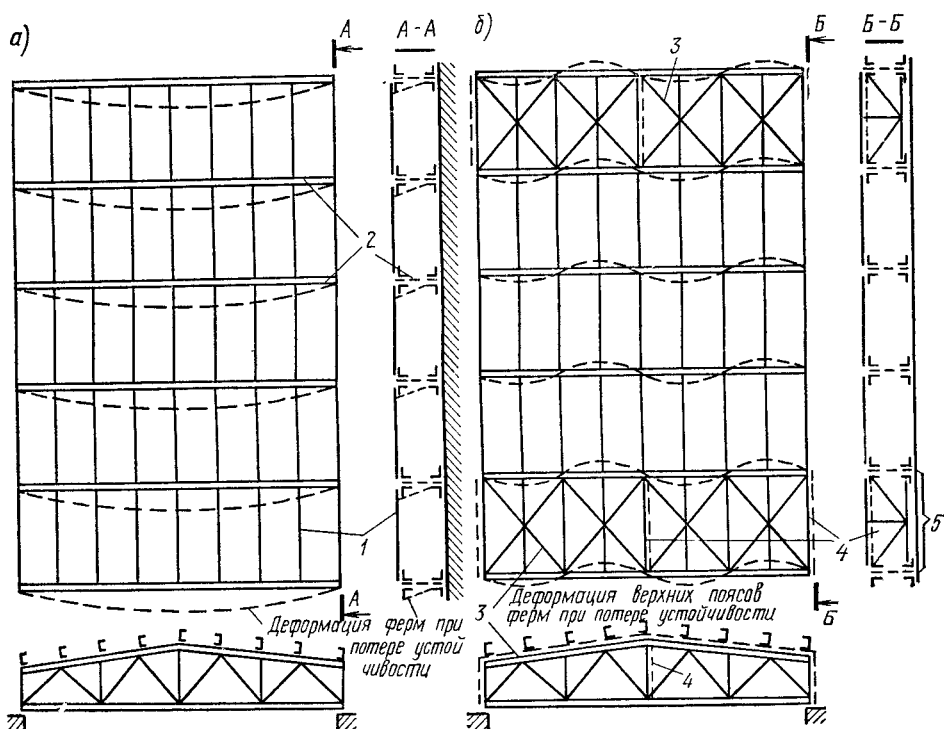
Связи, обеспечивающие устойчивость стропильных ферм
